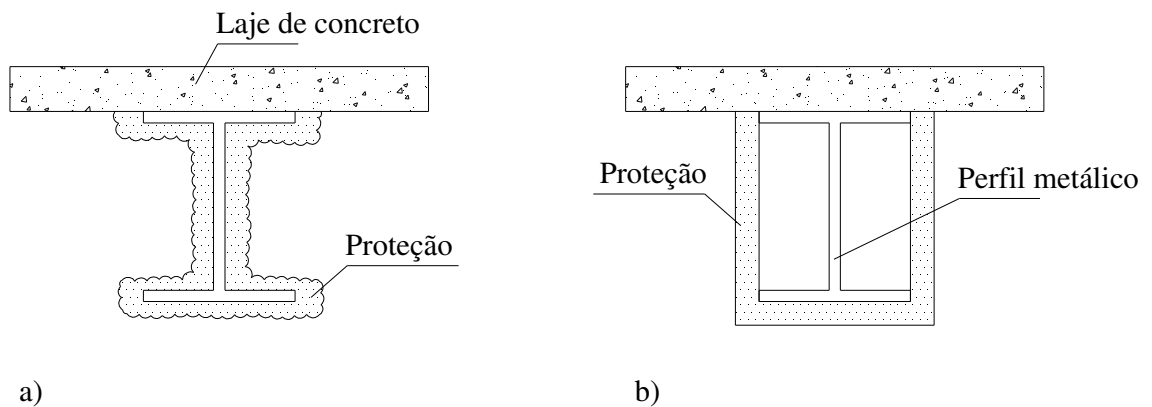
(a) Proteção tipo contorno e (b) Proteção tipo caixa, aplicados à uma viga I sobreposta por laje de concreto.
